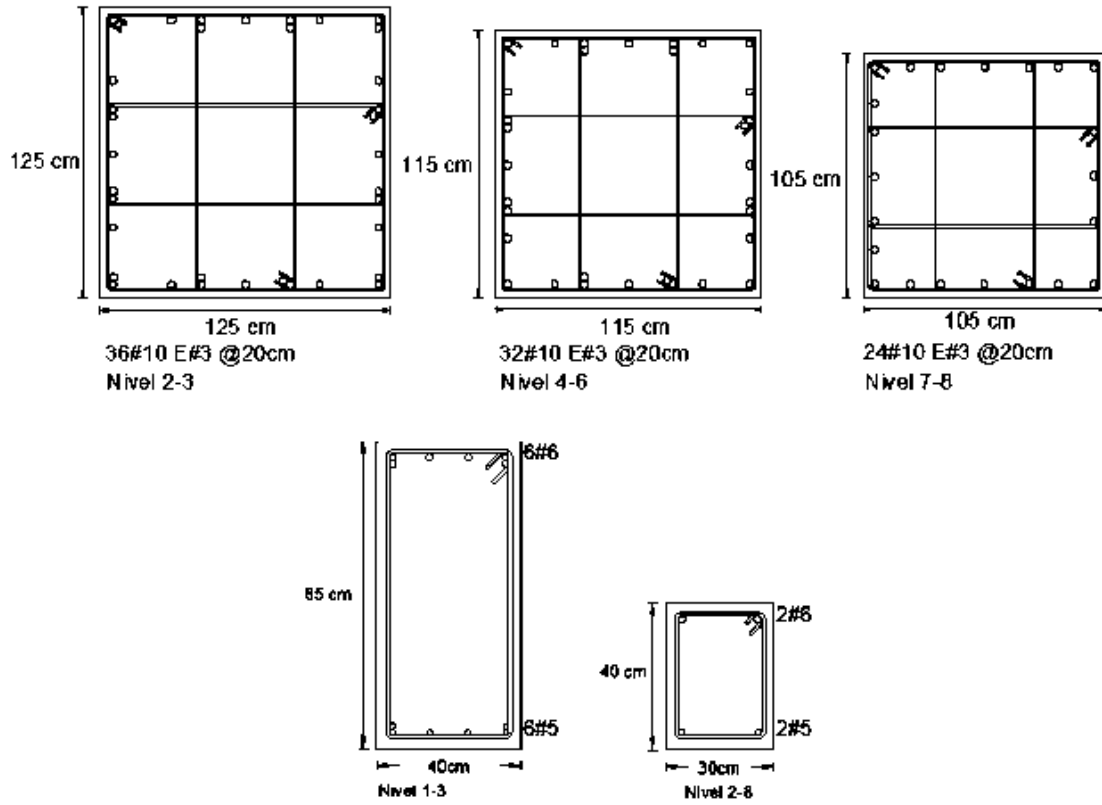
Secciones finales de columnas y vigas del edificio de 8 niveles diseñado con las NTCS-2017 y  $Q=4$  [imágenes tomadas de Gregorio, 2020]
